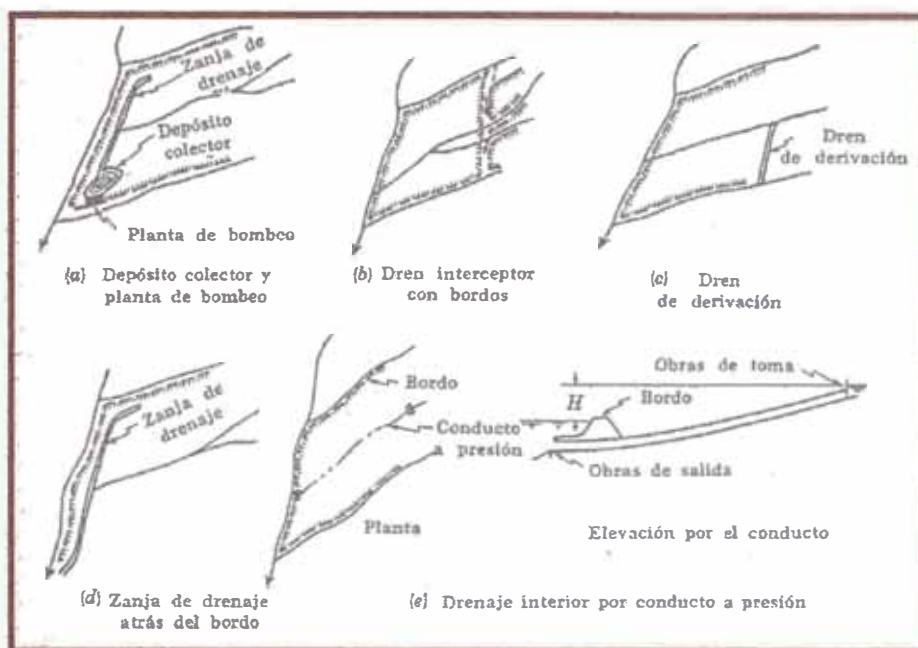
Algunas plantas para el drenaje interior de áreas bordeadas
